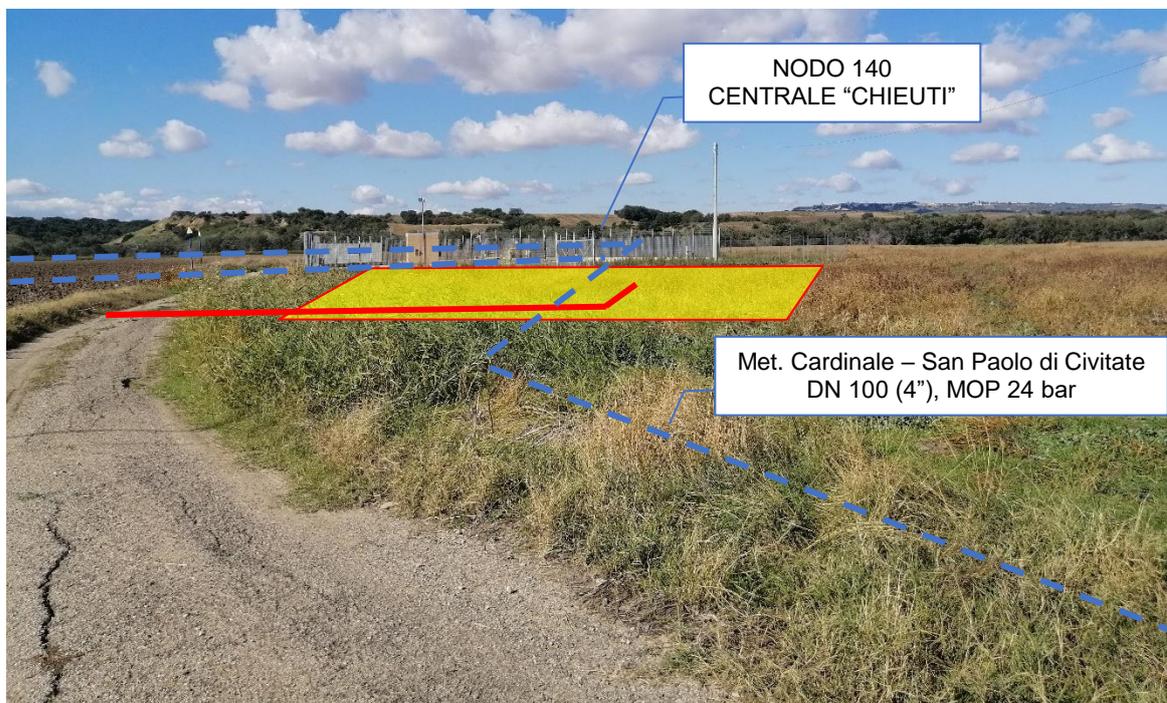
Area Impianto n° 19 (impianto trappola e PIL)
